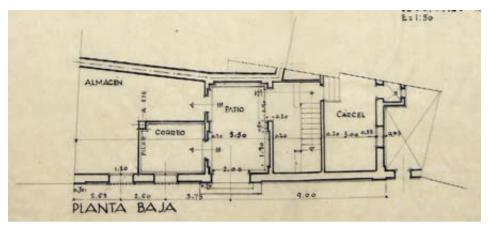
Planta baja del proyecto de casa consistorial de Aguilón, 1929 (A.D.P.Z.).
